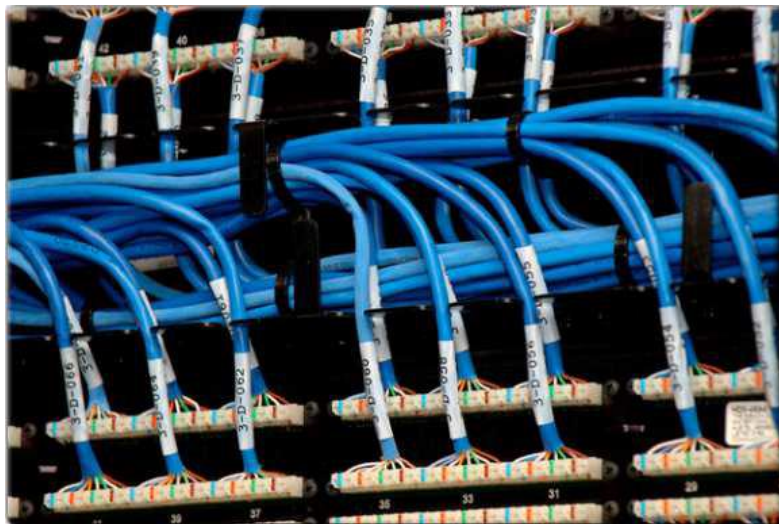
Cableado estructurado debidamente ordenado y etiquetado
